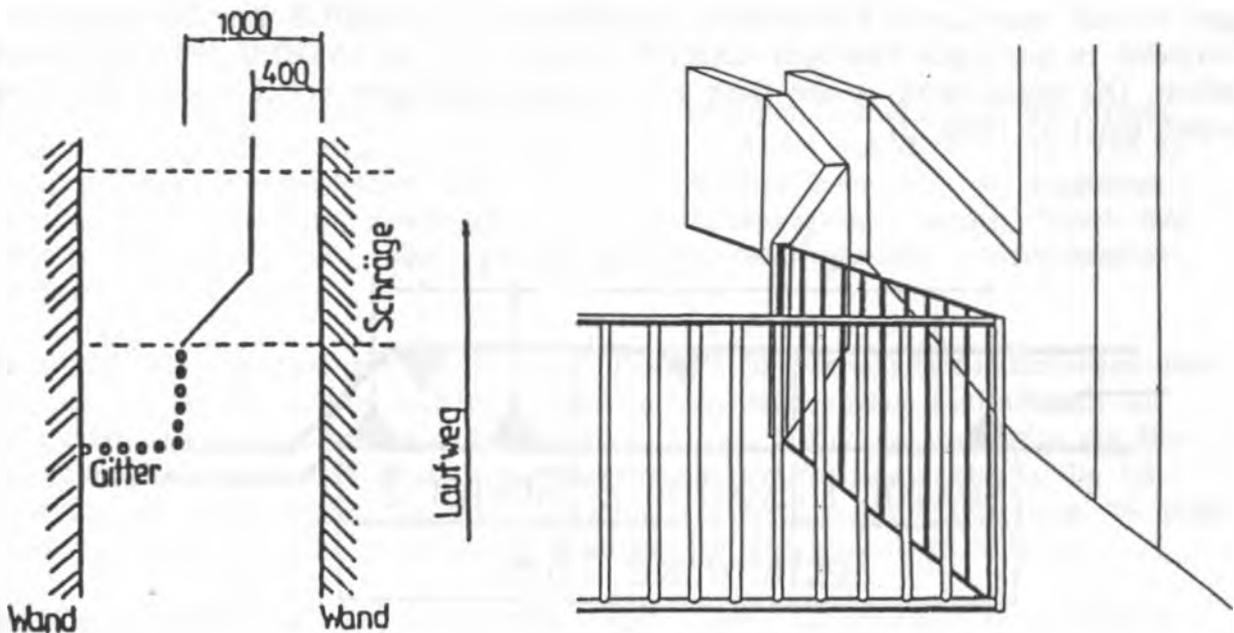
Verladerampe (Grundrisskizze; Kameraperspektive)
